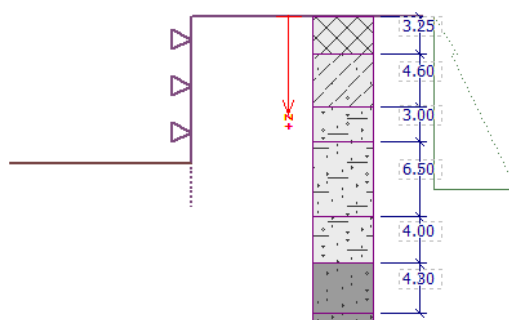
Расчетная схема шпунтового ограждения
